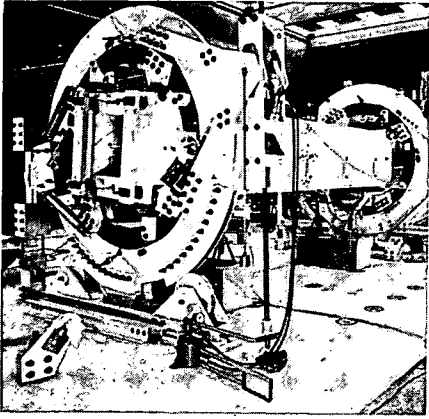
Dispositif d'essai à la torsion d'un caisson de section carrée de 1 m de côté.
